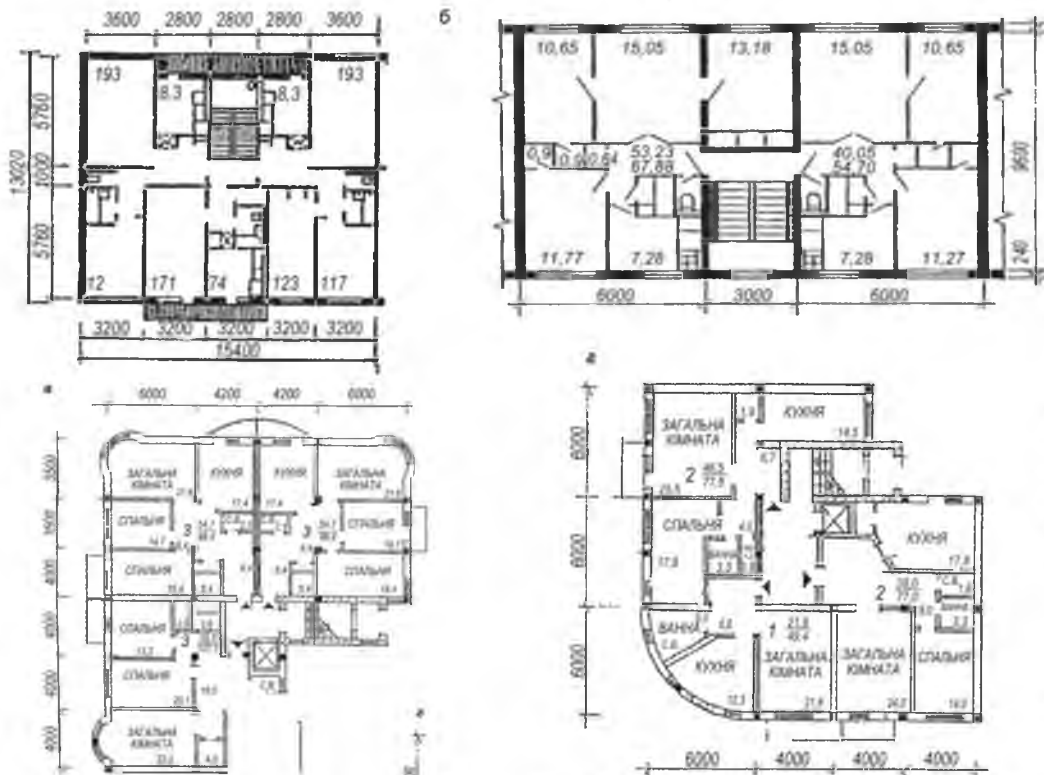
Планувальні схеми секційних житлових будинків: а - торцева
